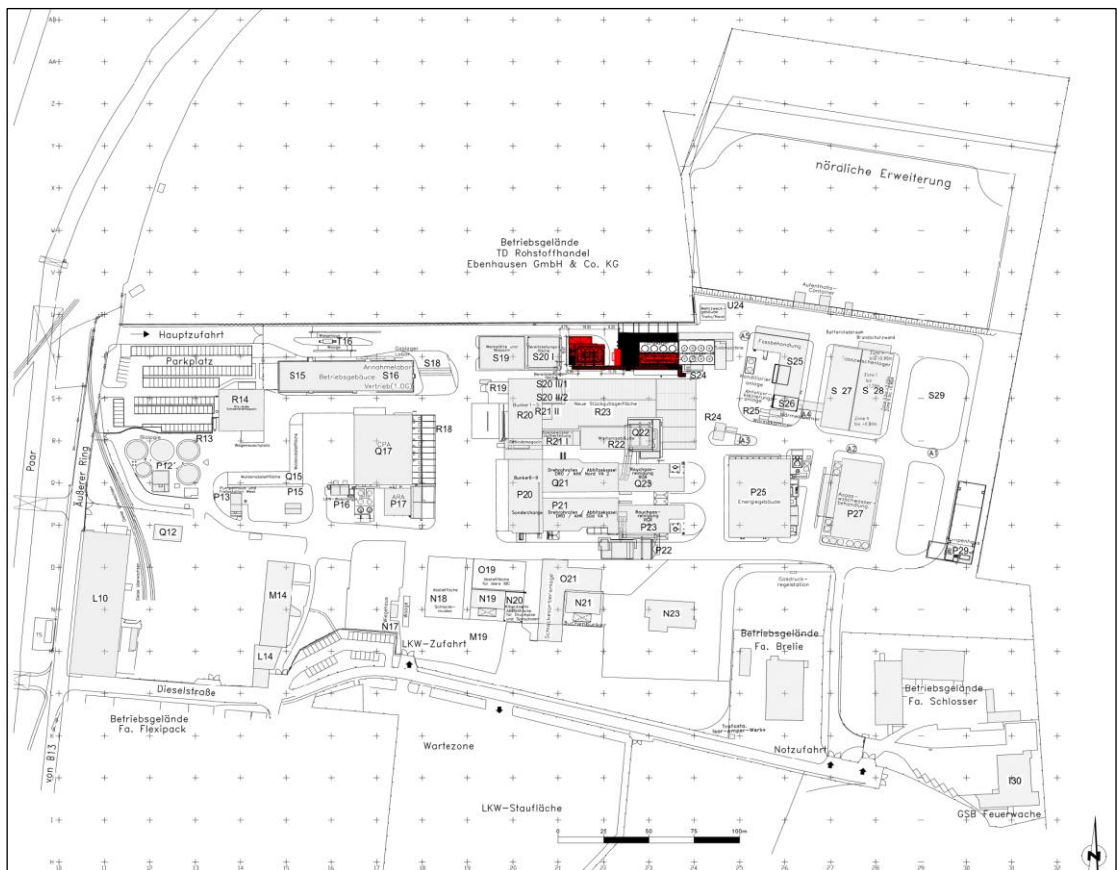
Lageplan des Tanklagers (Quelle: IA-Tech GmbH)
